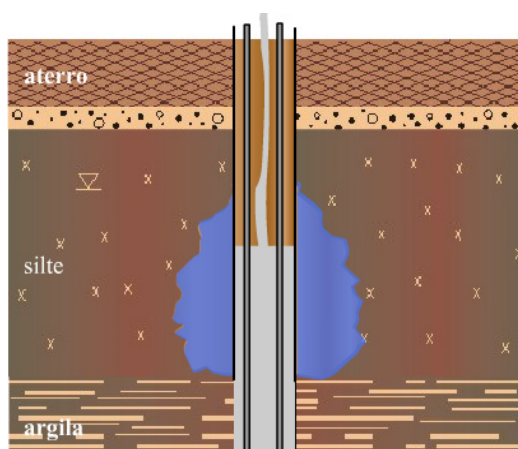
Bulbo proveniente do colapso preenchido de água enquanto o concreto é lançado na estaca
